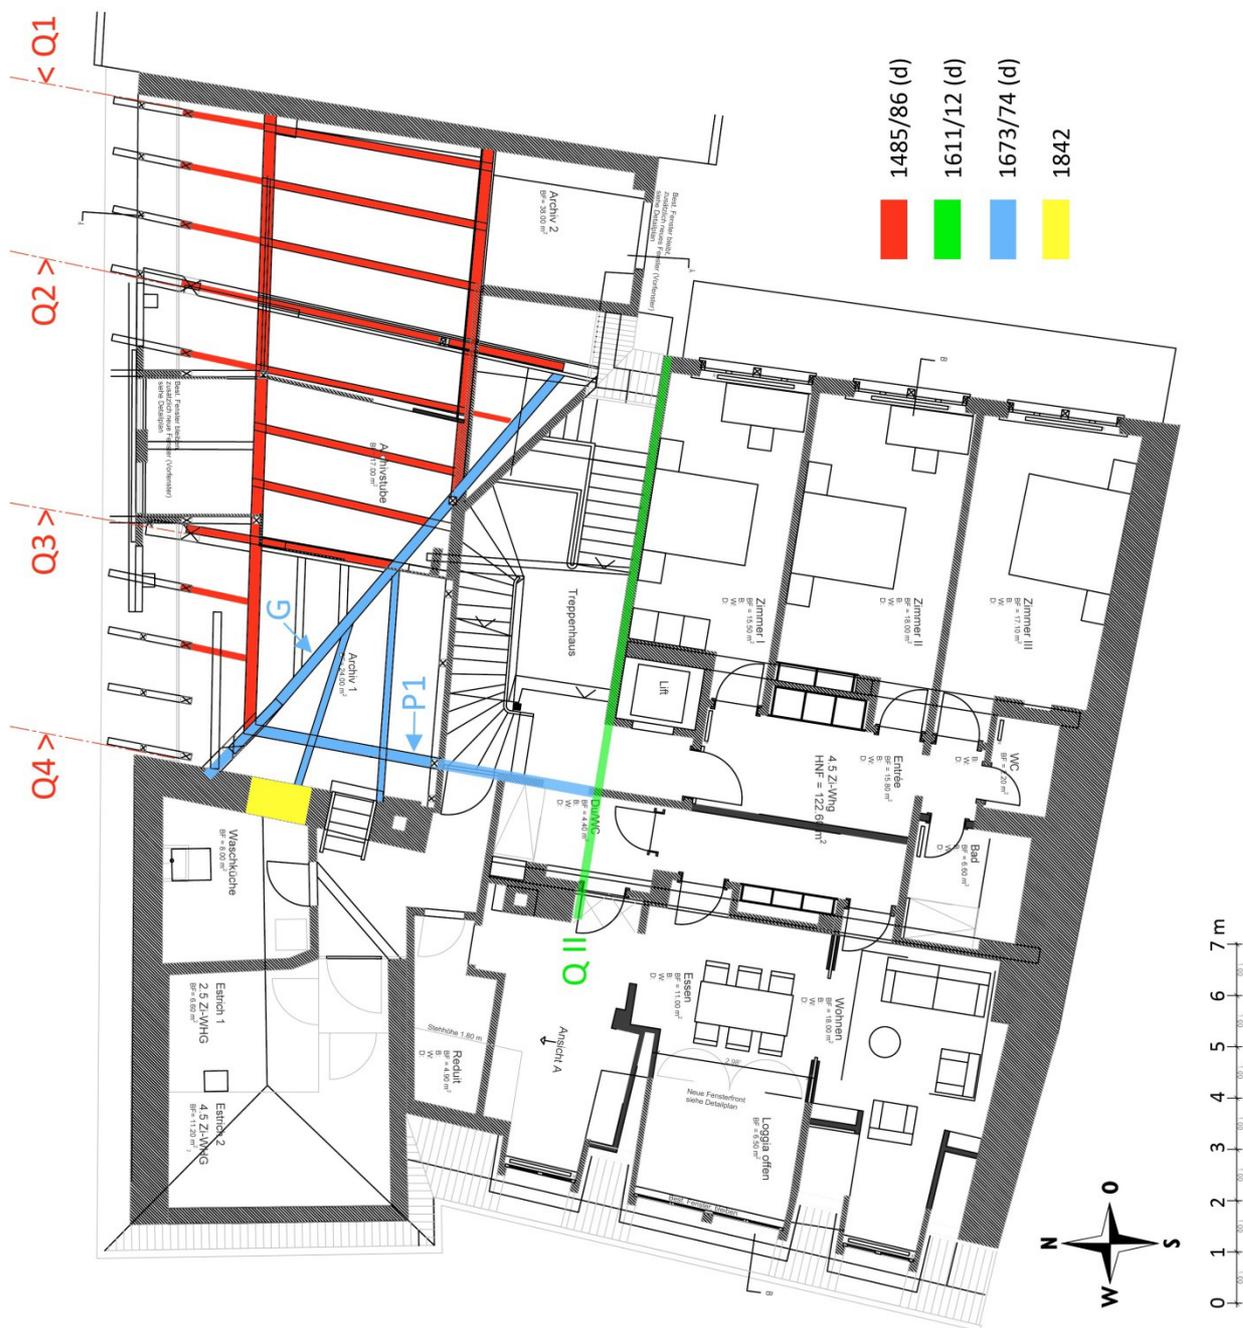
Korporationsgebäude. Grundriss 1. Dachgeschoss (Nordhaus) und 3. Obergeschoss (Südhaus).
